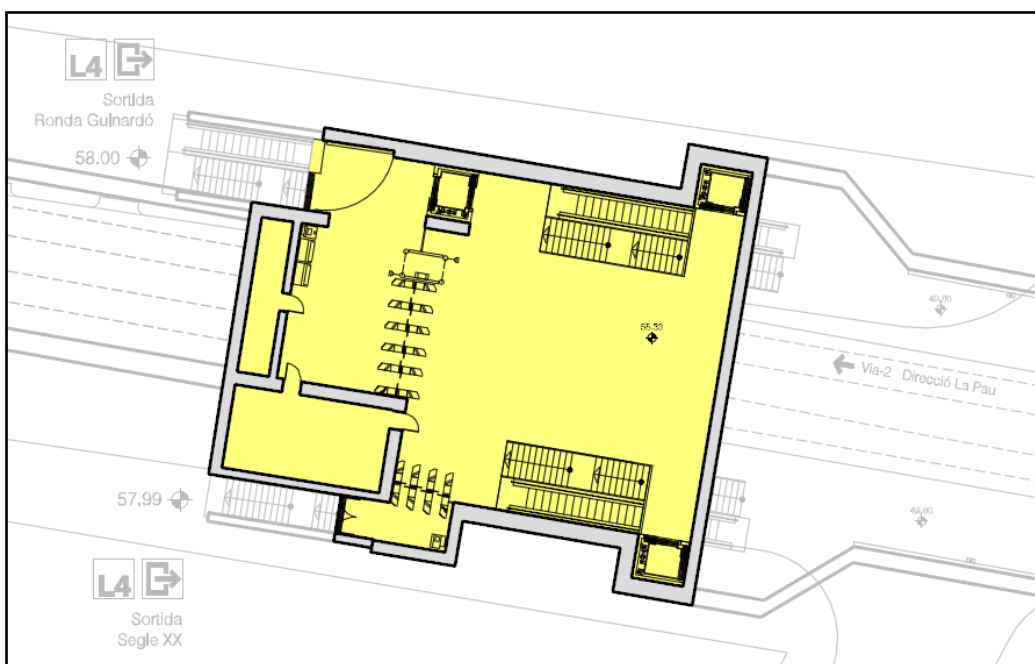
Planta del vestíbul Ronda Guinardó (L4)
